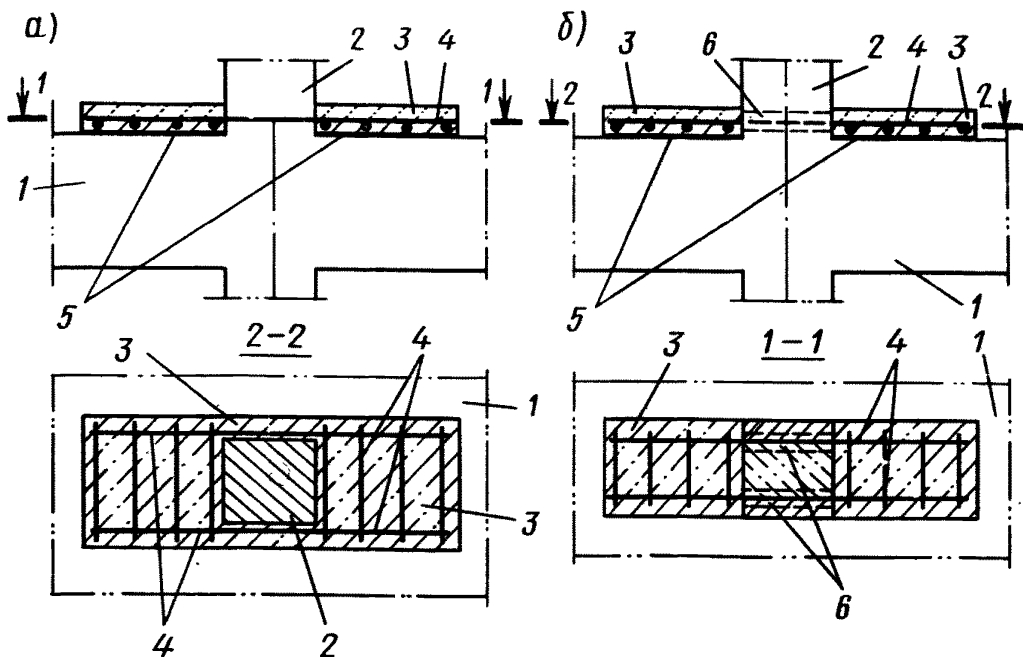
Усиление опорной зоны изгибаемых конструкций наращиванием бетона с укладкой арматуры
